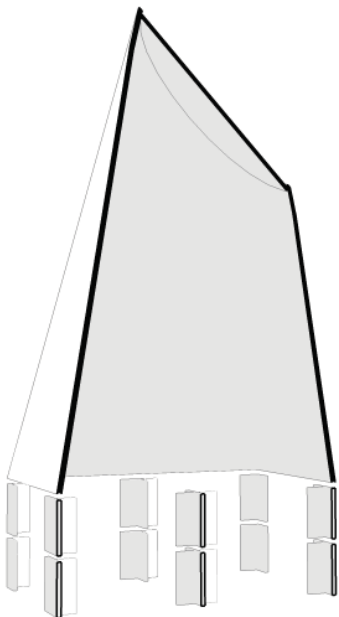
Estructura de la cáscara apoyada en los muros pantalla. Fuente: MCHS.
